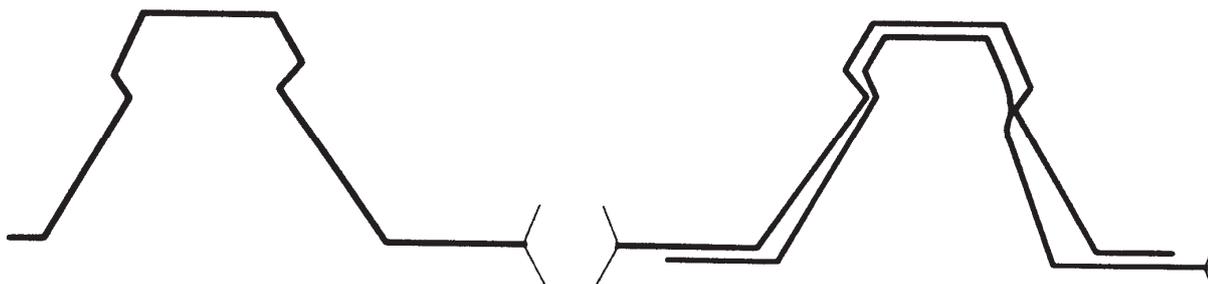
Typisches Profil mit verdeckten Verbindungen
